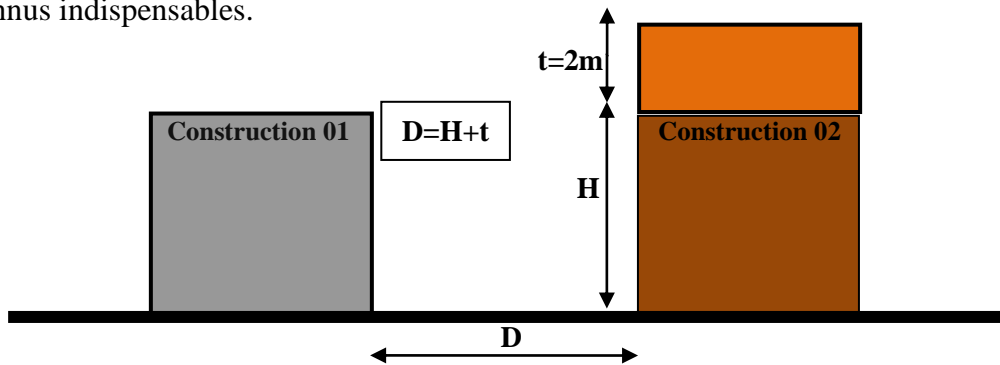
Coupe définissant la tolérance sur la hauteur d'une construction en bordure d'une voie plane.
